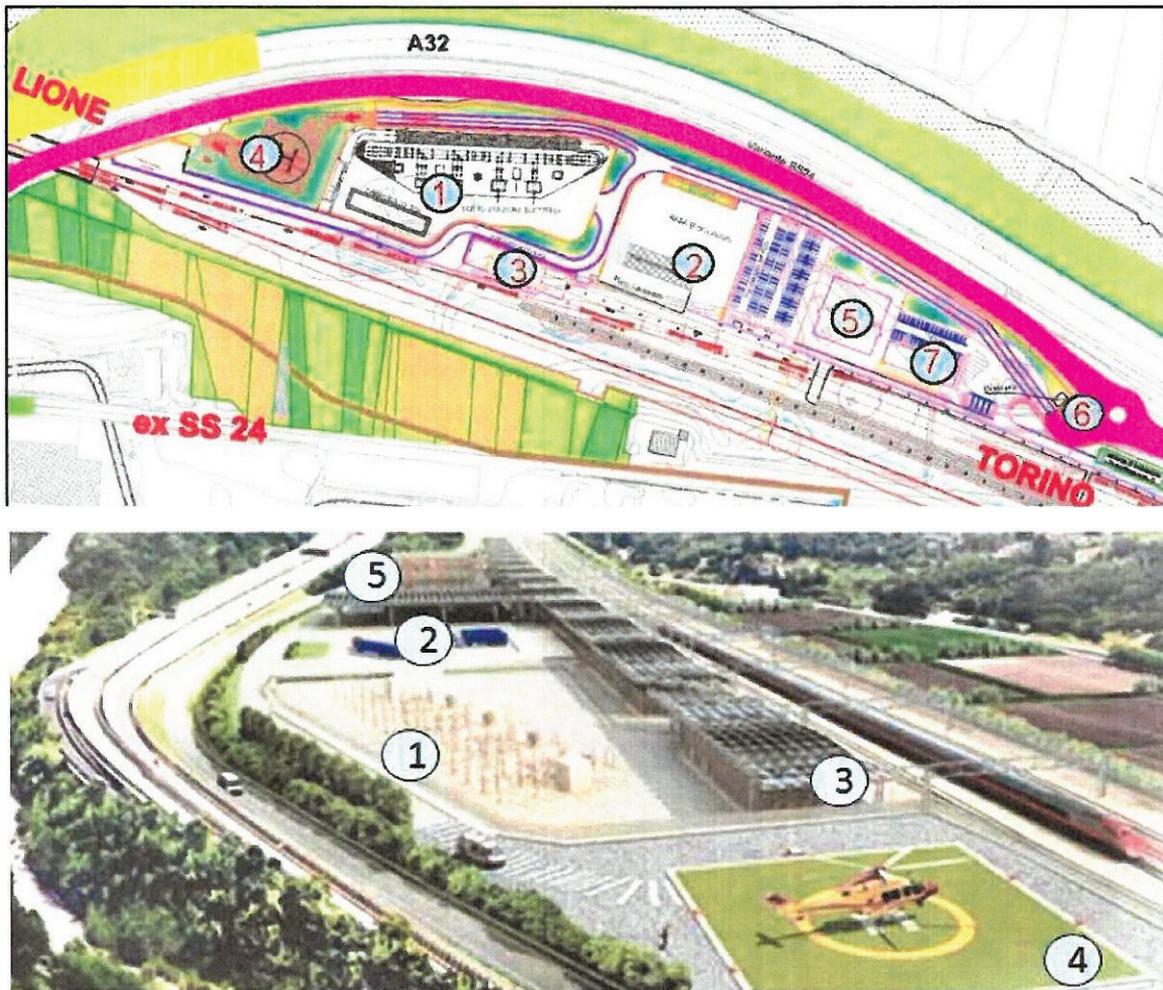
Schema planimetrico e render esemplificativo dell'area tecnica e di sicurezza
